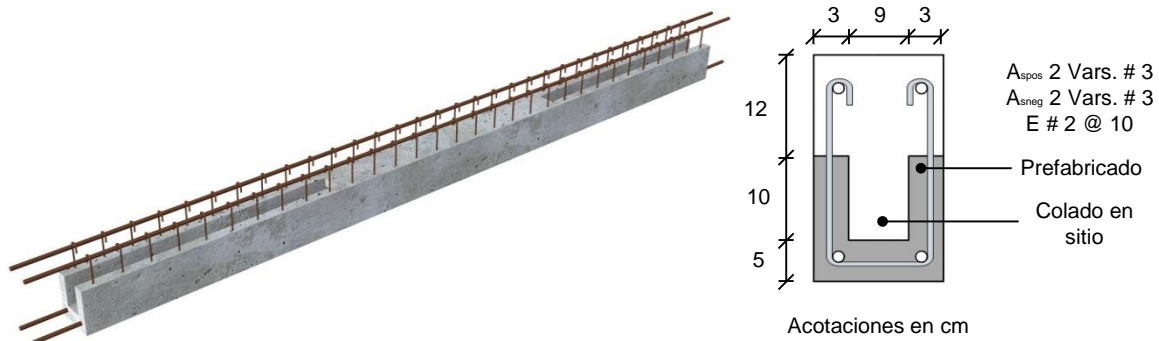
Vista en isométrico y sección transversal de traveses T-2
